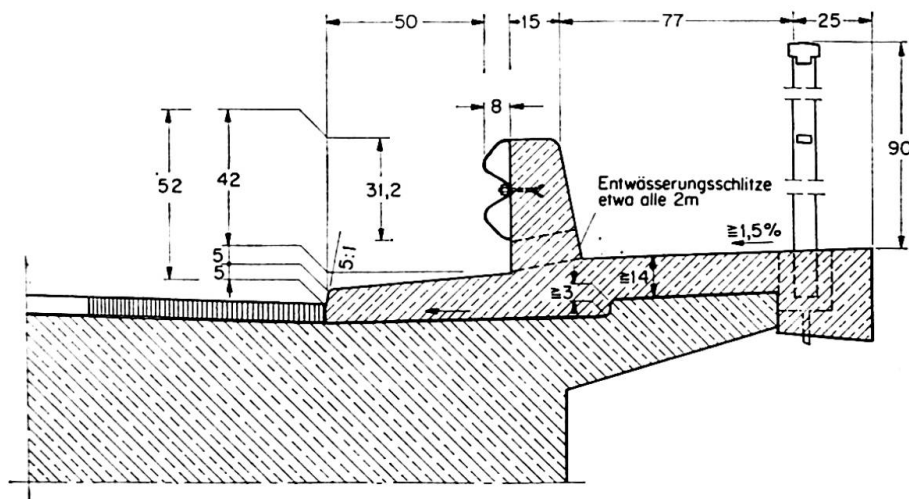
Durchlaufende Stahlleitplanke vor Beton-Leitschwelle mit senkrechter Vorderkante.
